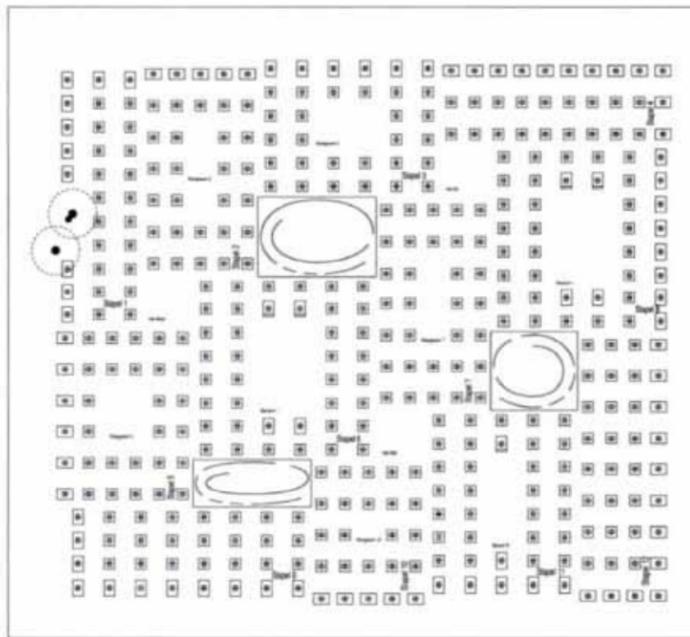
Plan de fondation et des lames en acier structurant, Zumthor, 2000
